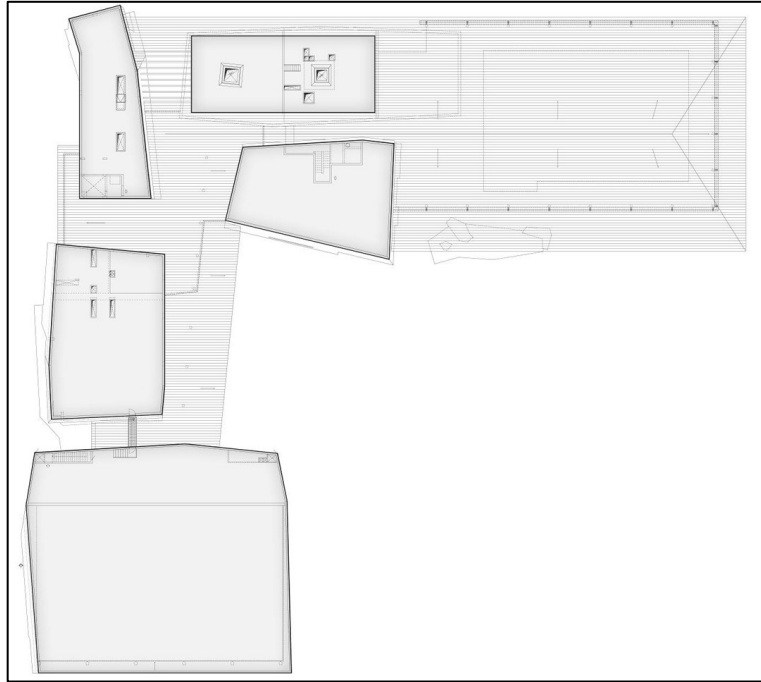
Plano de Techos Centro de Rehabilitación Beit Halojem
